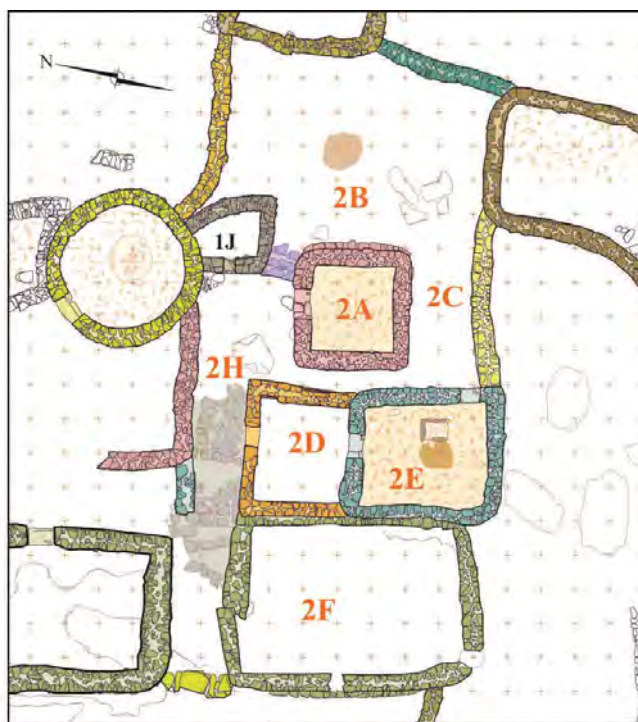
Planta de los espacios y diferentes estructuras murarias de la unidad 2
